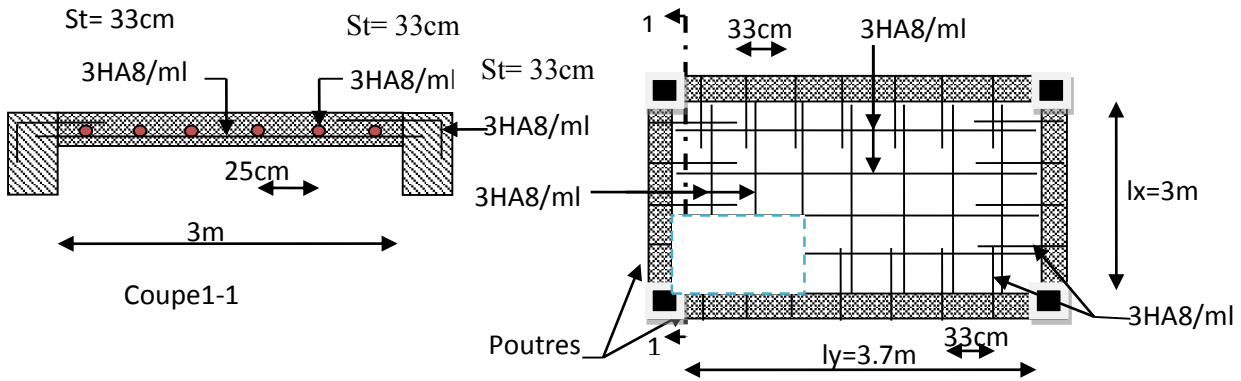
schéma de ferrailage de la dalle sur 4.
